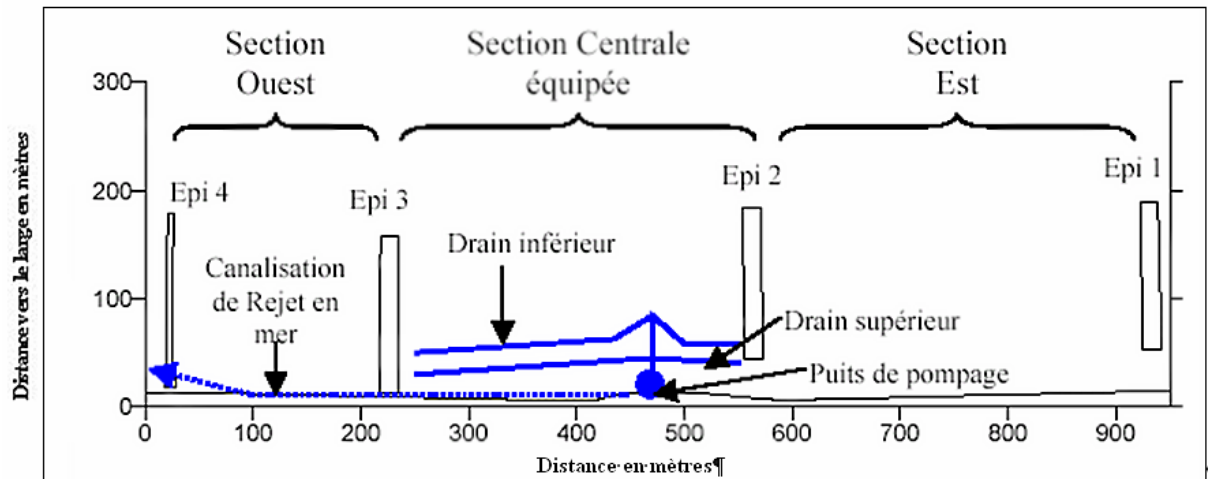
vue en plan du système de drains installé à Villers-sur-Mer et extension de la zone de suivi topographique (source : J.M. COUTON)
